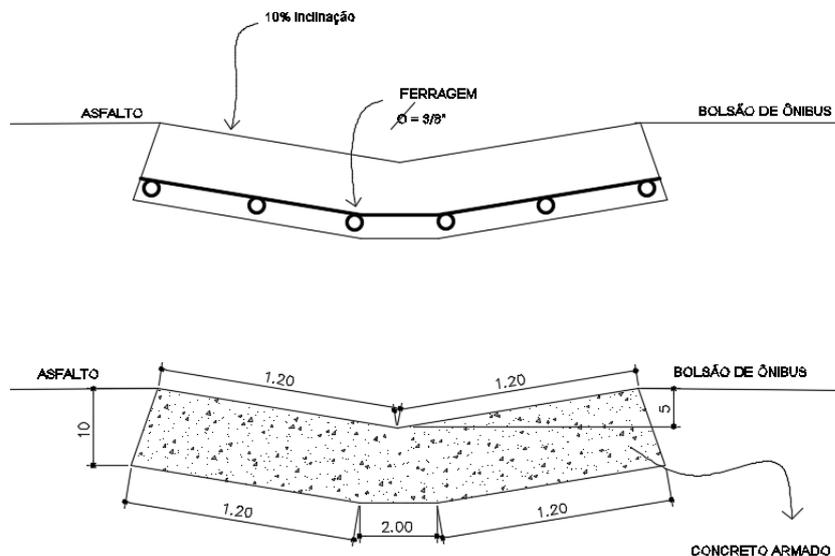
Detalhamento/Corte da sarjeta onde será feito entre o asfalto e o bolsão.
